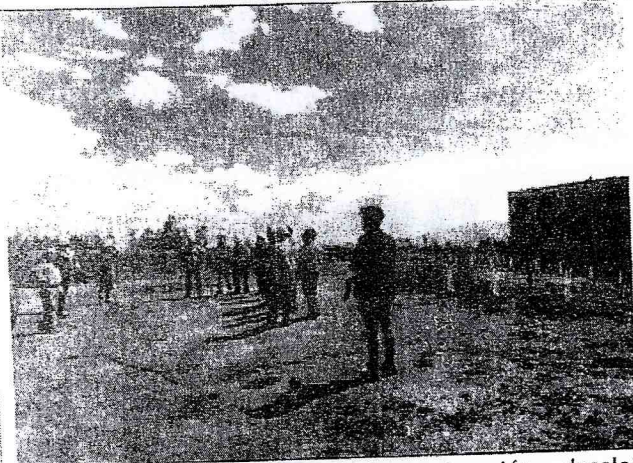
Vista exterior de la construcción – desalojo de trabajadores
